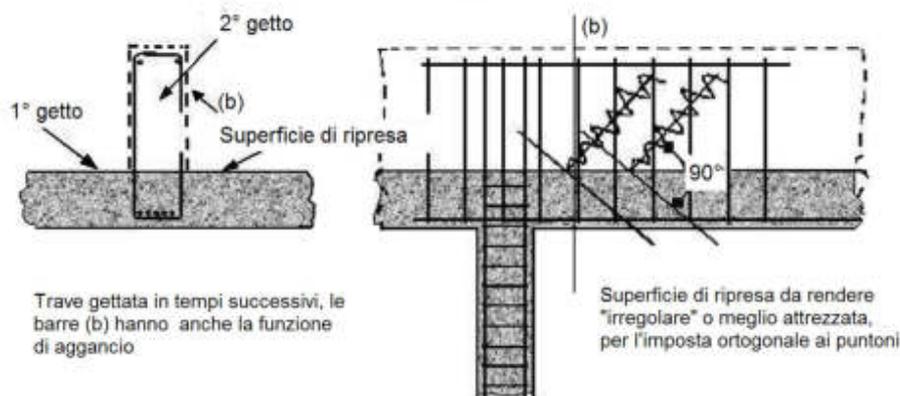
Modalità di ripresa del getto su travi di spessore elevato
